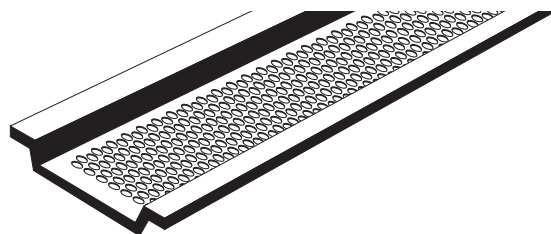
Непрерывная софитная вентиляционная секция пропускает воздух снаружи здания внутрь и монтируется с нижней стороны карниза.
